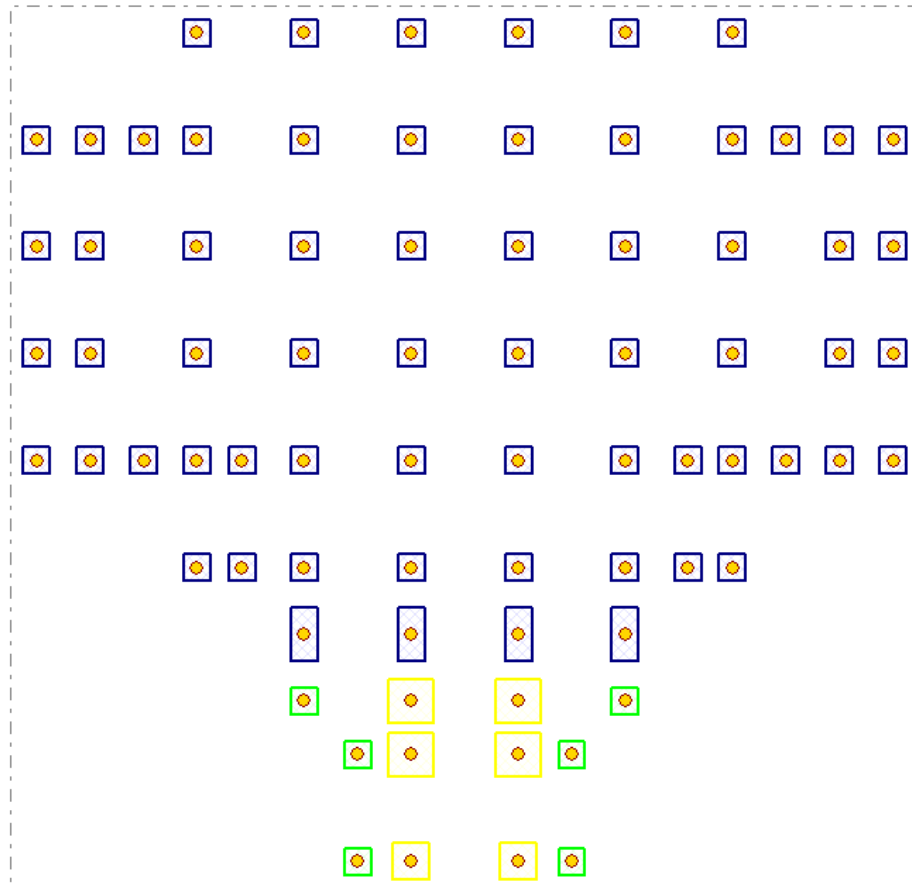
Mini Pile Tiang Kelompok dengan Panjang 2,5 m (untuk beban 300 kN – 499 kN)
